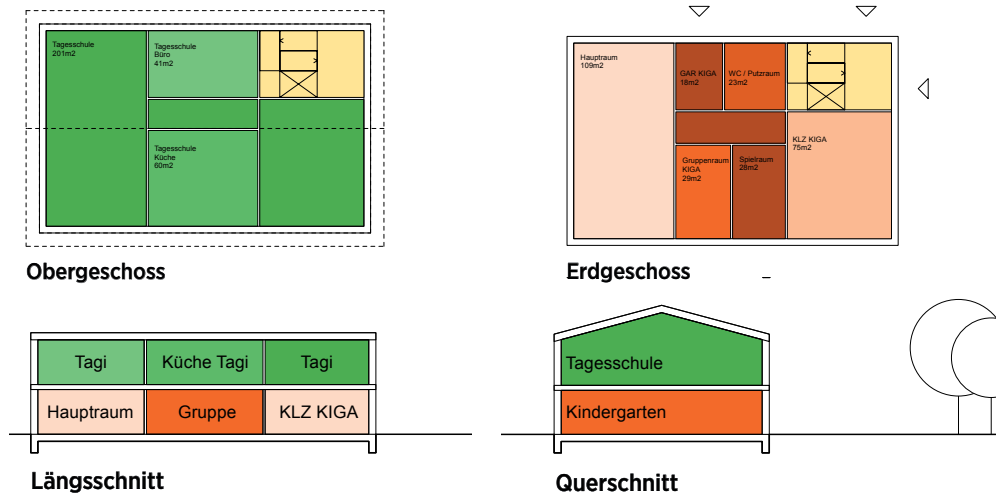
Grundrisse KIGA / Tagesschule (Bearbeitungsteam)
